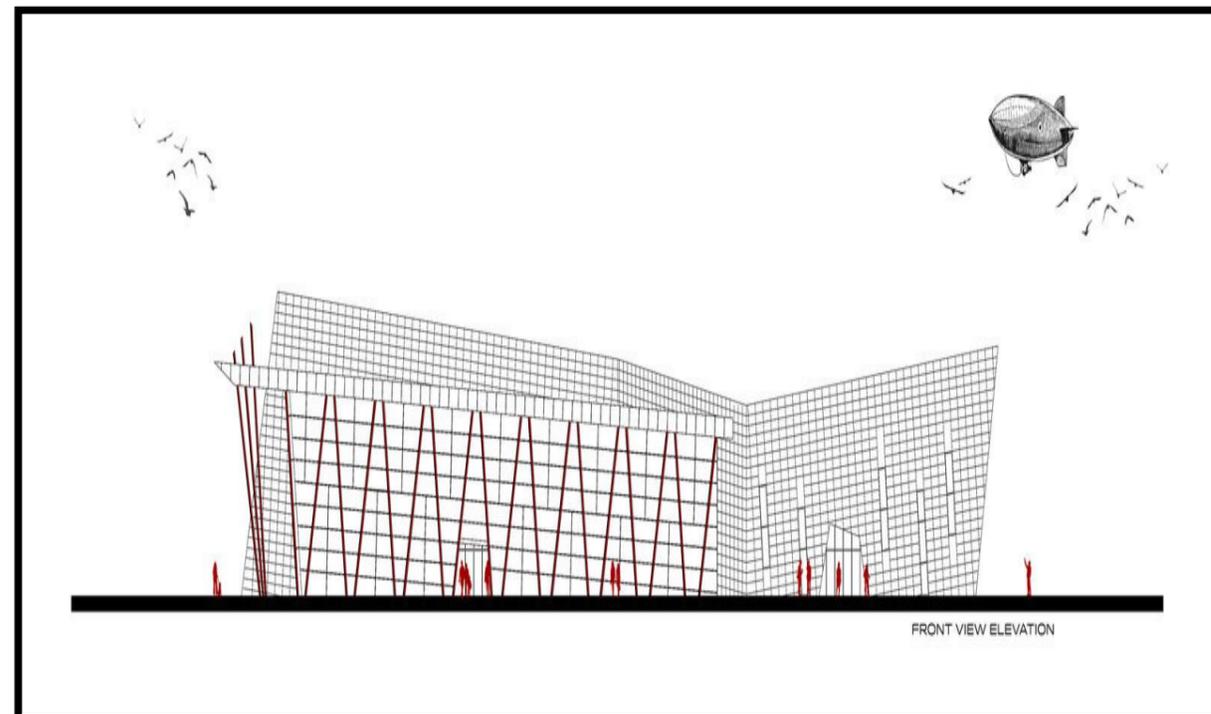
Elevación Izquierda de la terminal de Kayseri. Fuente: Plataforma Arquitectura.
